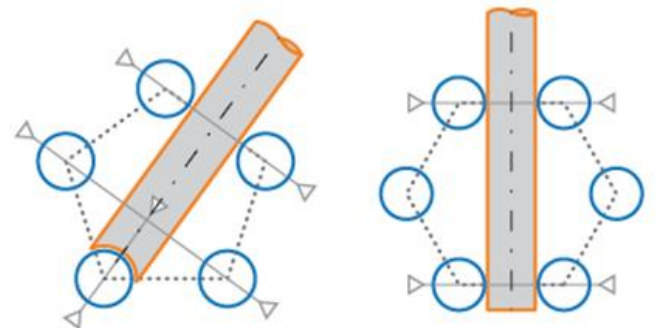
Vista en planta de la disposición pentagonal y hexagonal de pilares
